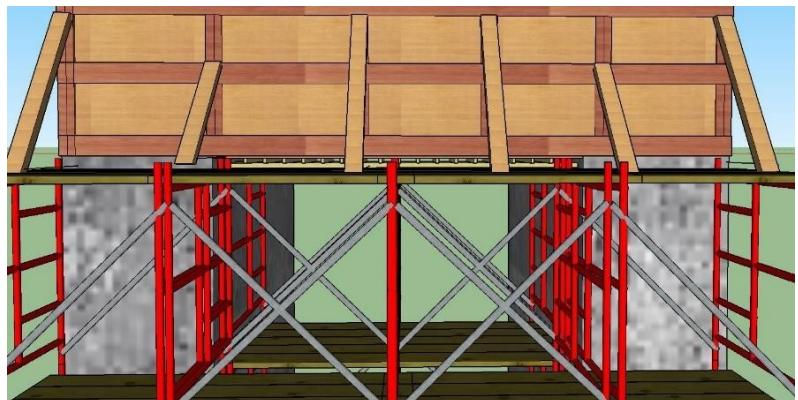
32 Ilustrasi Pembetonan lantai kerja
